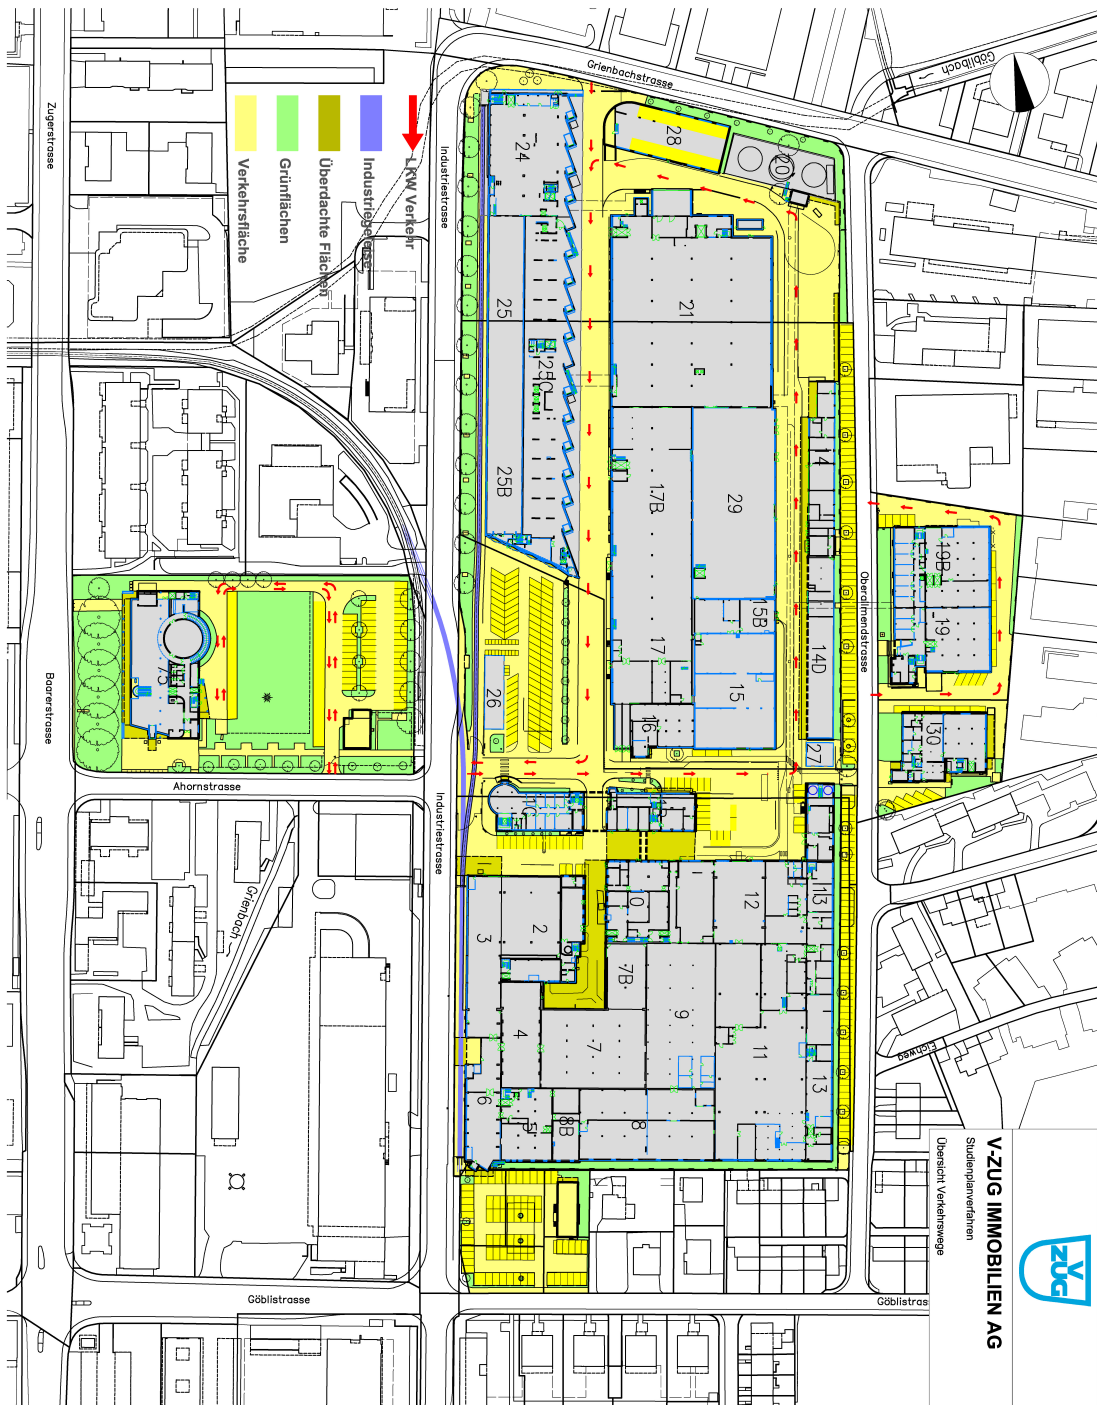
Erschliessung Parkplätze V-Zug Bestand.
